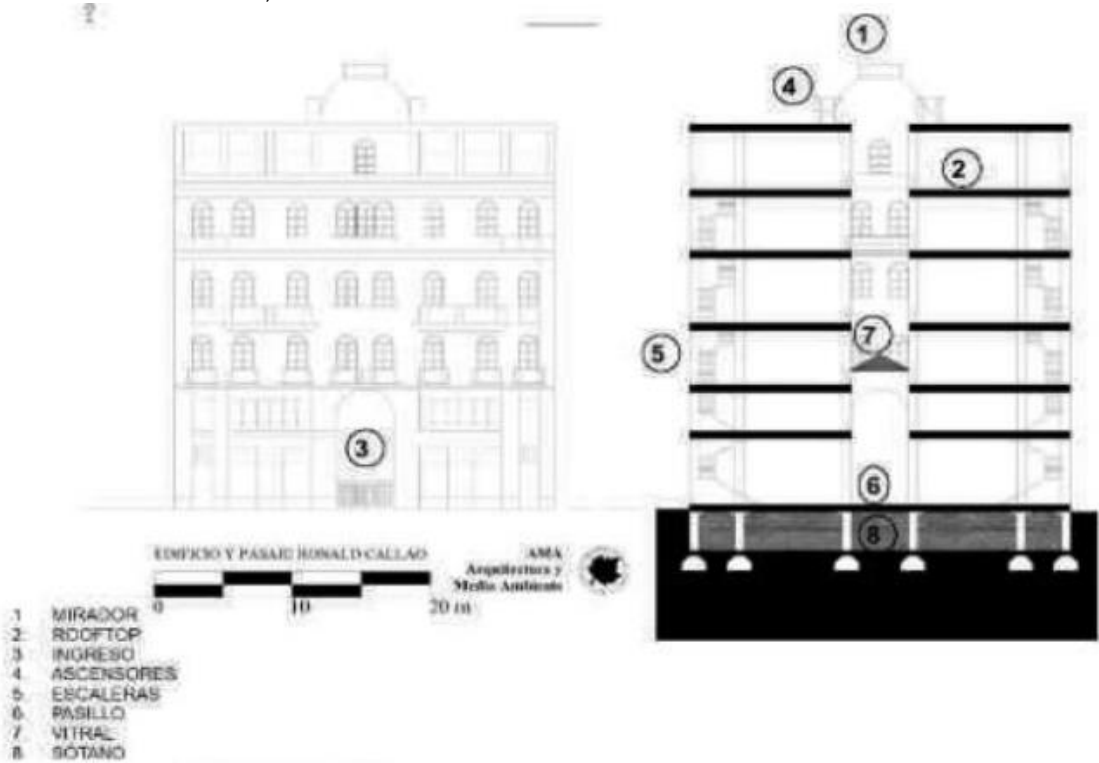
Elevación frontal y corte arquitectónico del edificio Ronald.
